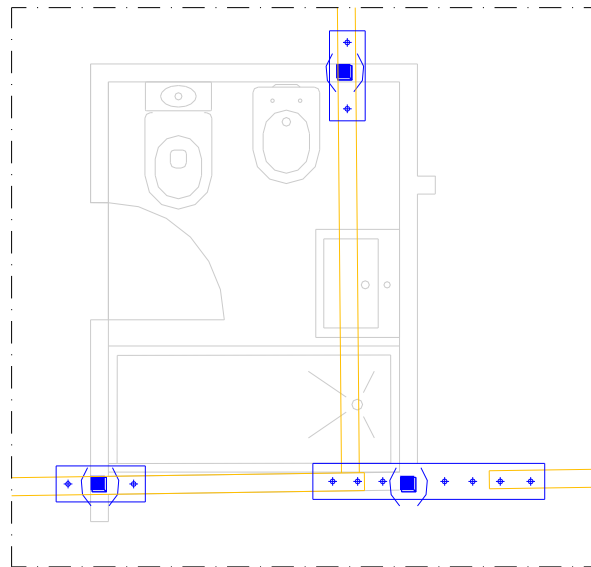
Ligação das chapas de fundação dos pilares à parede resistente (planta)
